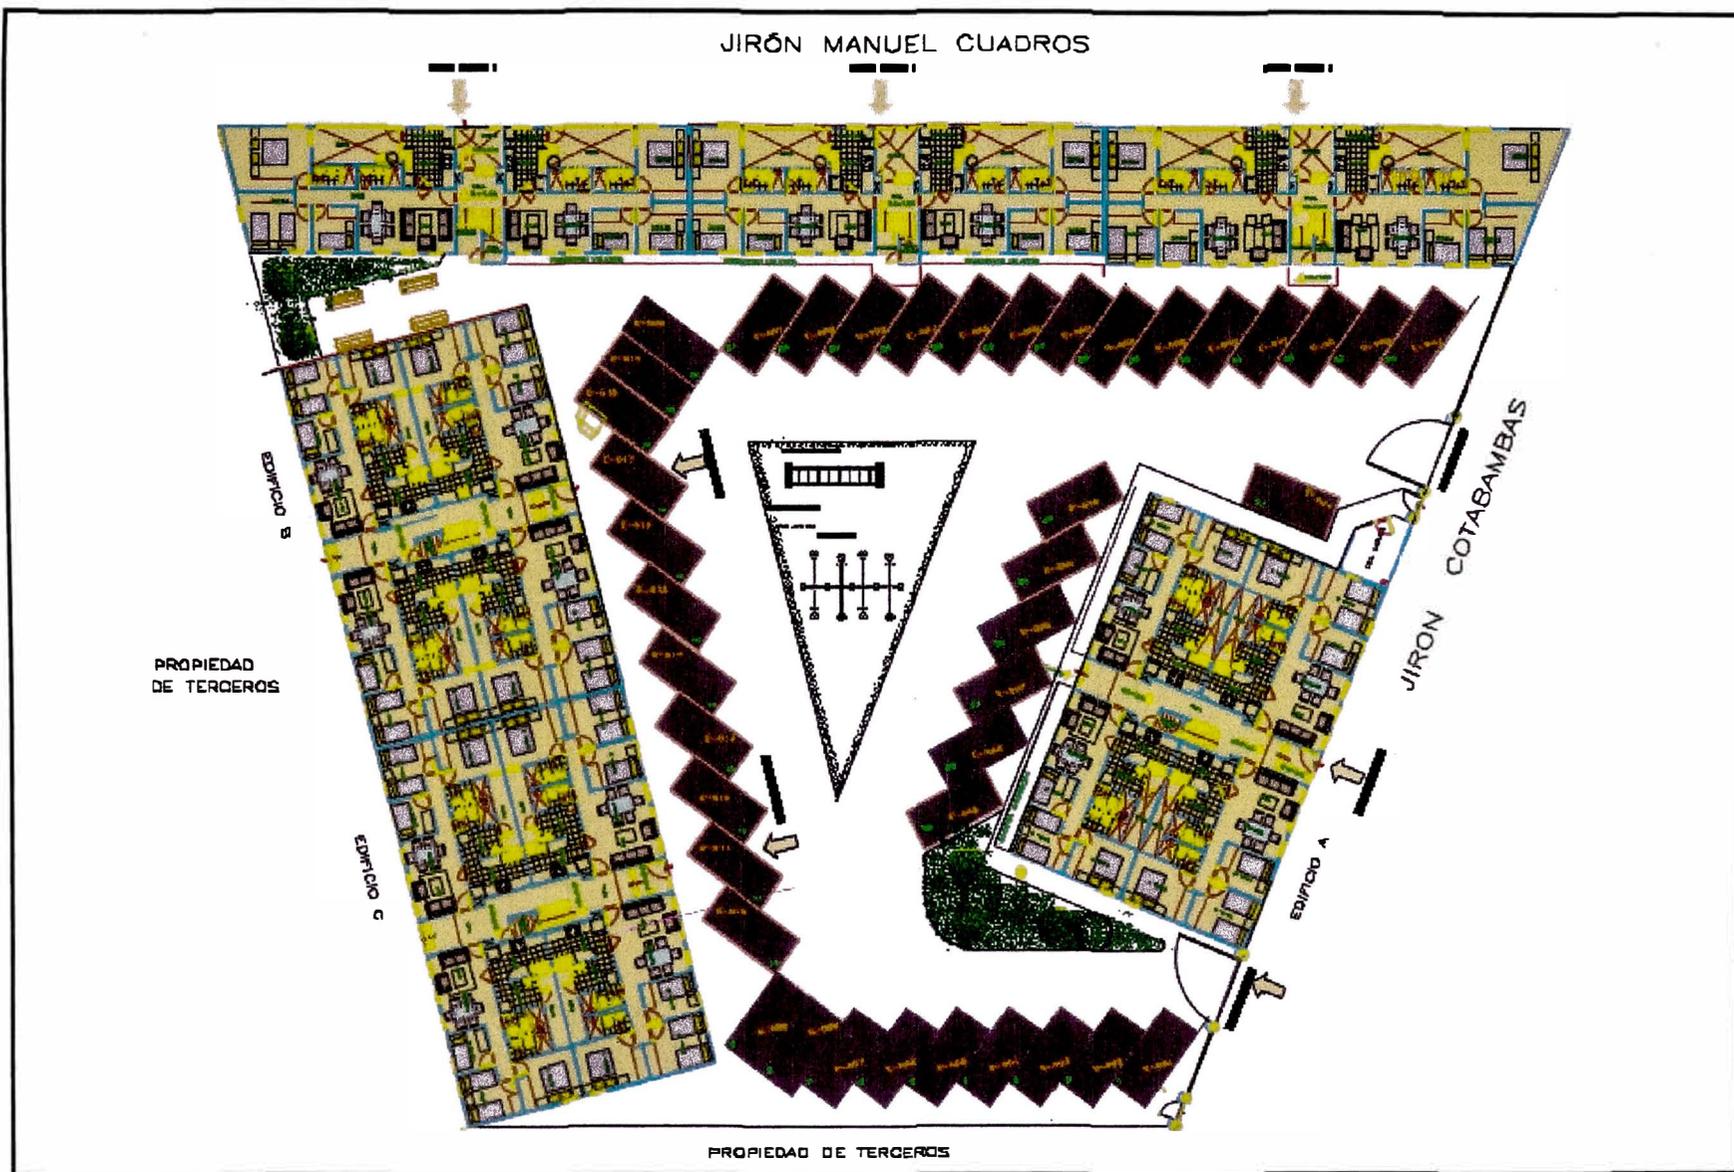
Vista en planta del proyecto Edificio Multifamiliar Cotabamba
